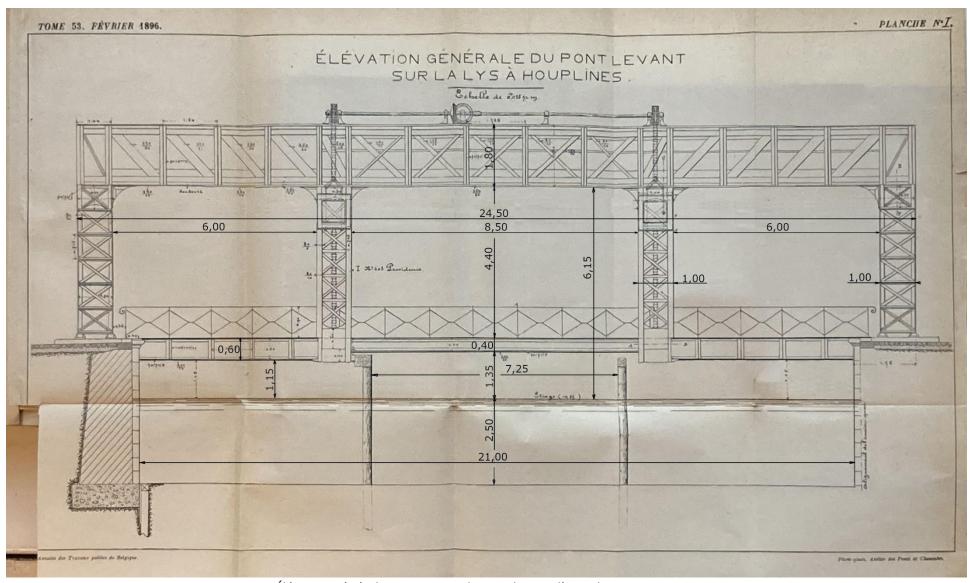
Élévation générale et structure du pont levant d'Houplines construit en 1892. (dessin extrait des *Annales des Travaux Publics de Belgique*²)
